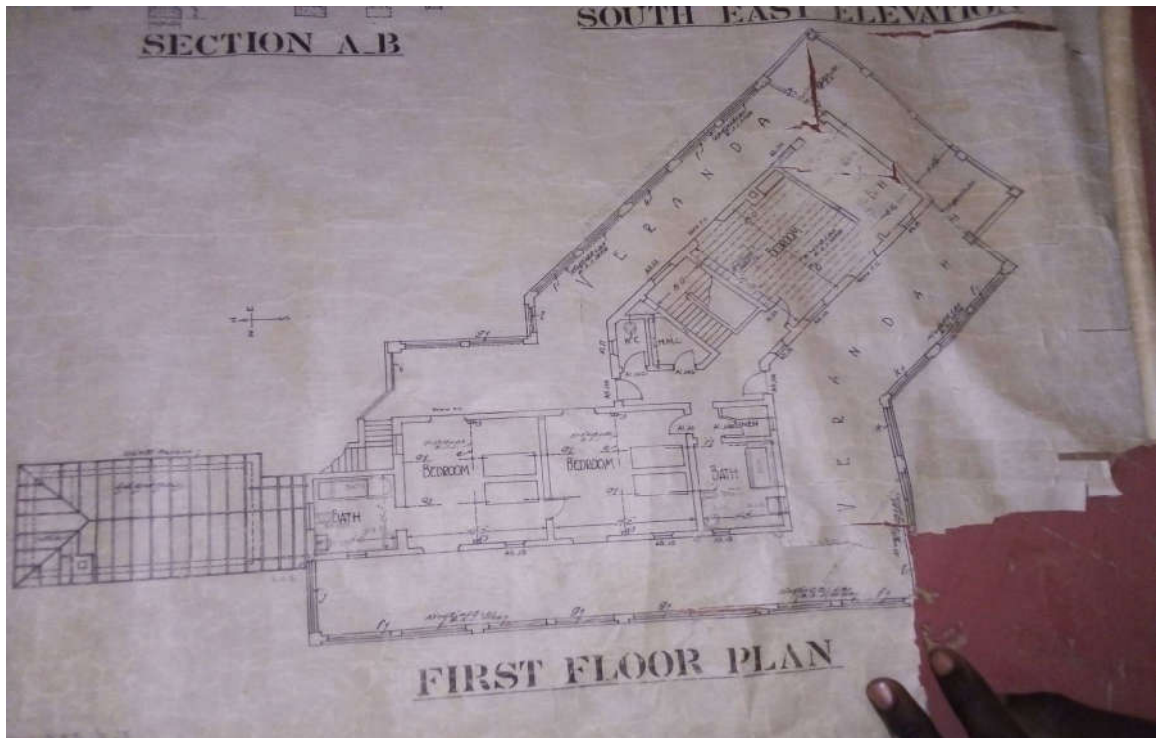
يوضح المسقط الامامي لمنزل رقم واحد
